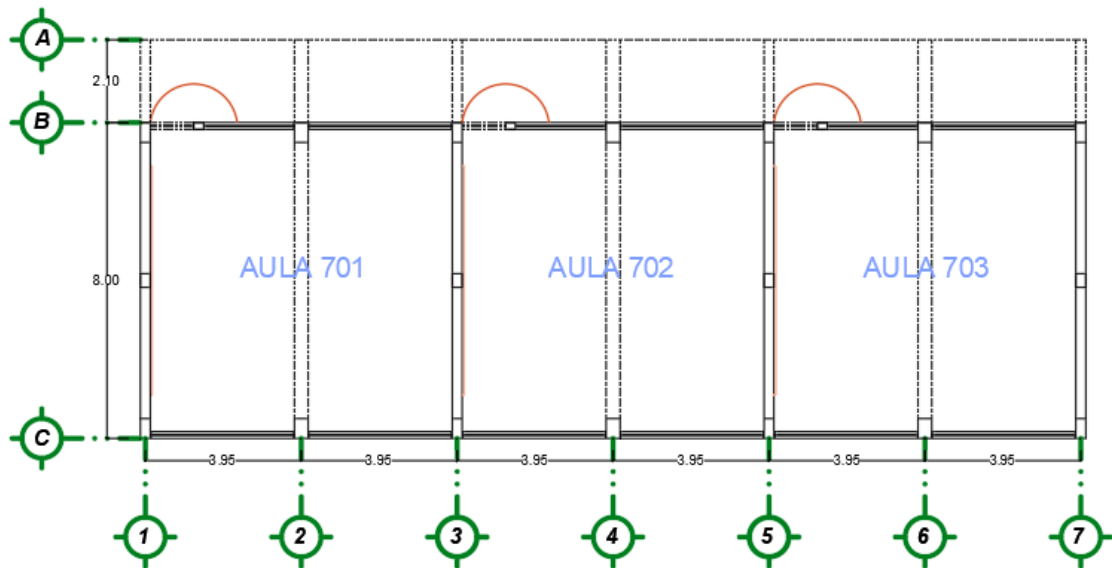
Planta típica del pabellón 7. Fuente: Elaboración propia
